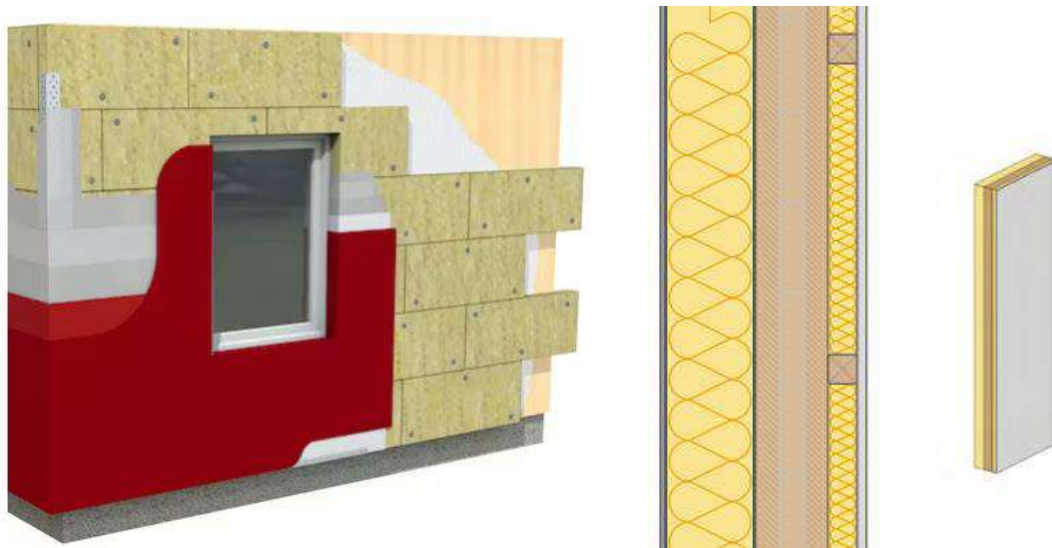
Fachada de tablas de madera con aislamiento exterior (SATE)
